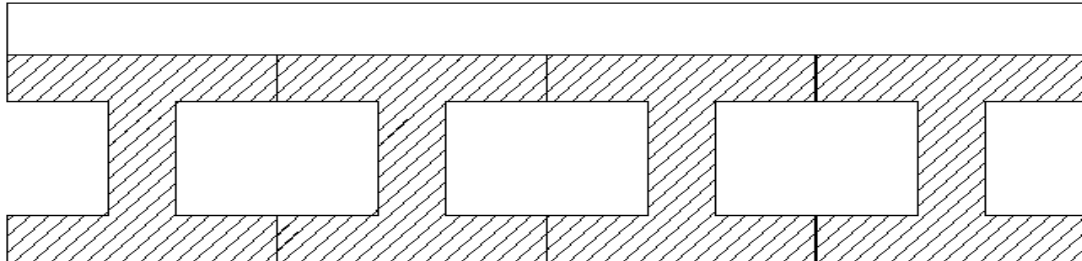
DISPOSICION DE LAS VIGAS EN UN PUENTE
